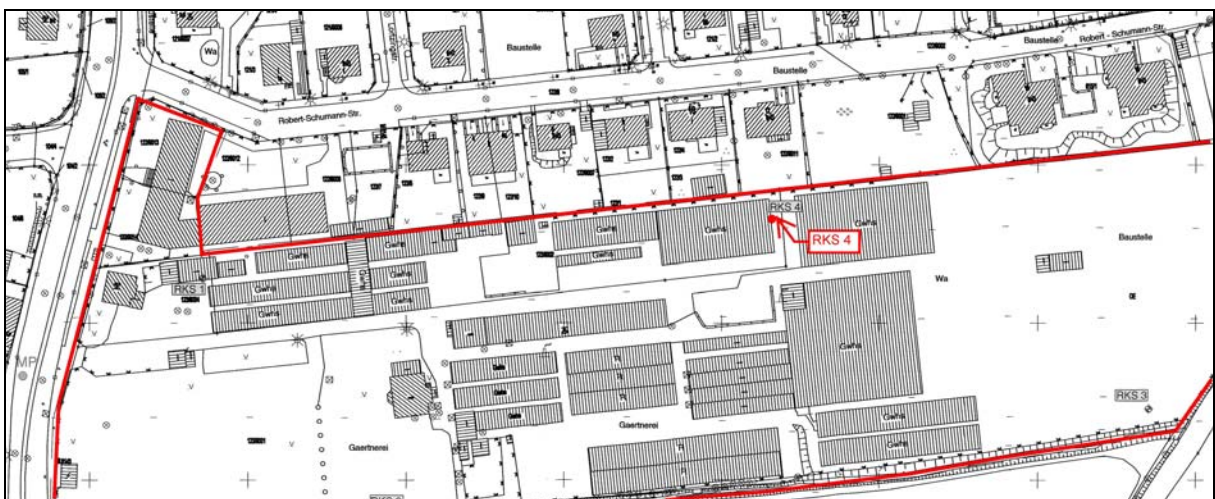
Lage der Rammkernsondierung RKS 4 (FCB GMBH, 2009)
